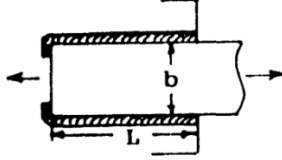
Ángulos soldados lateralmente por solo uno de sus lados y combinación de soldadura lateral y frontal
